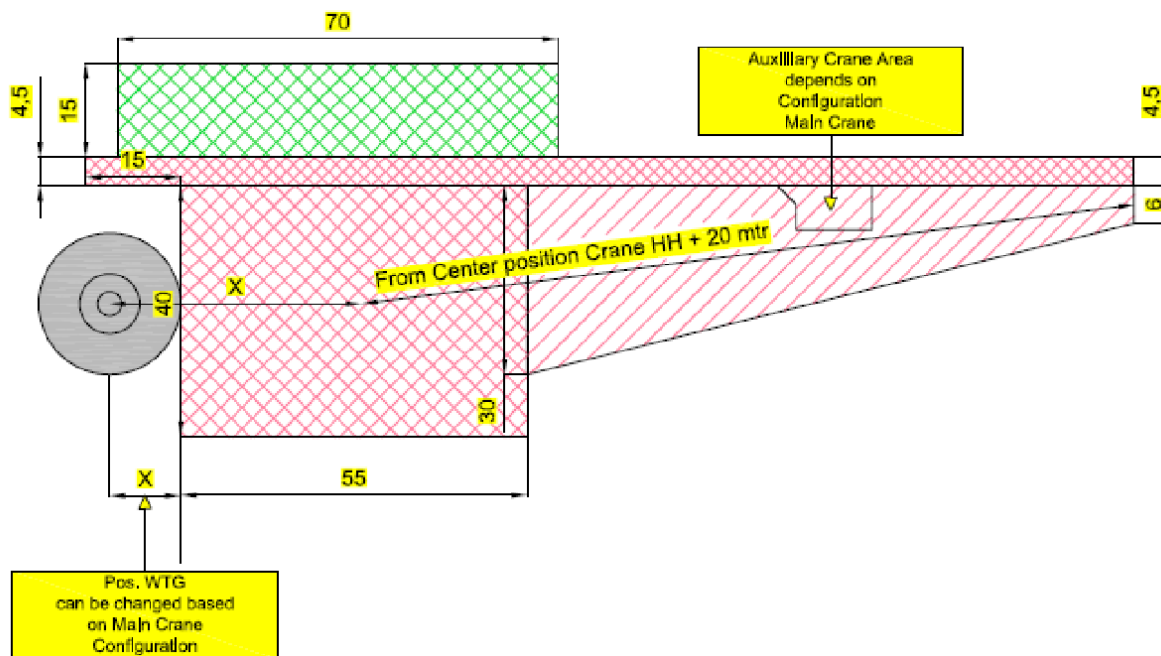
Schema piazzola in fase di cantiere per il montaggio dell'aerogeneratore.
